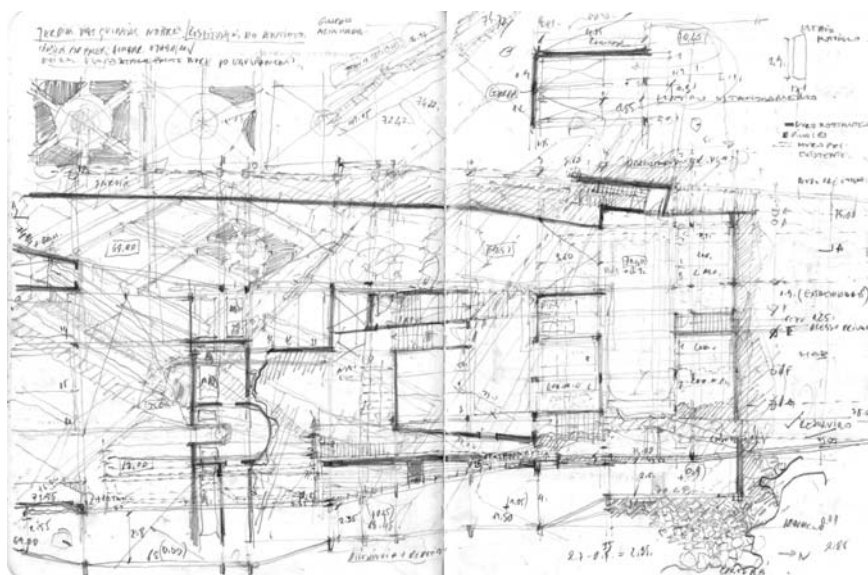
Planta da cobertura do parque de cafetaria / estacionamento / galeria e equipamento. 1.200.
